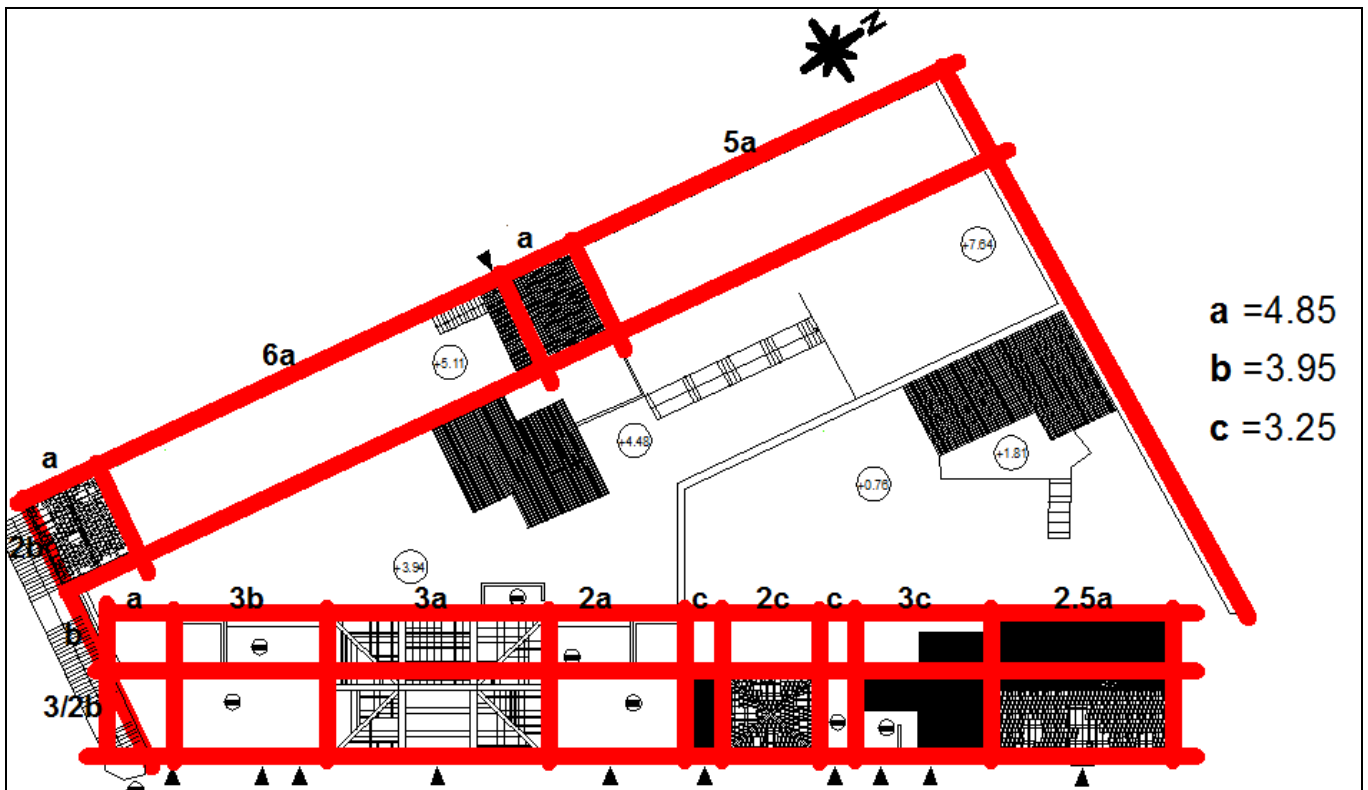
structure en mur porteur (coupe 2) source : *auteur
